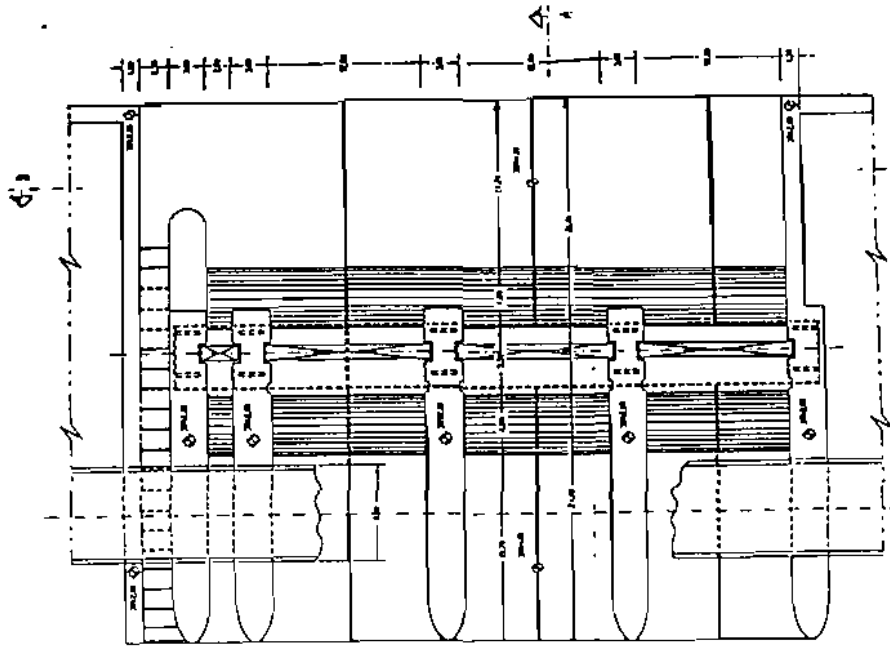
COMPUERTAS EN AGUALLAMAYA - PLANTA Y SECCIONES
